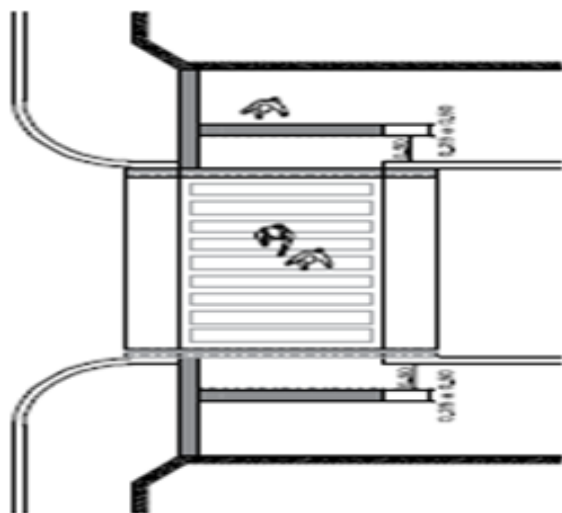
Planta baixa de uma faixa elevada com sinalização tátil.
